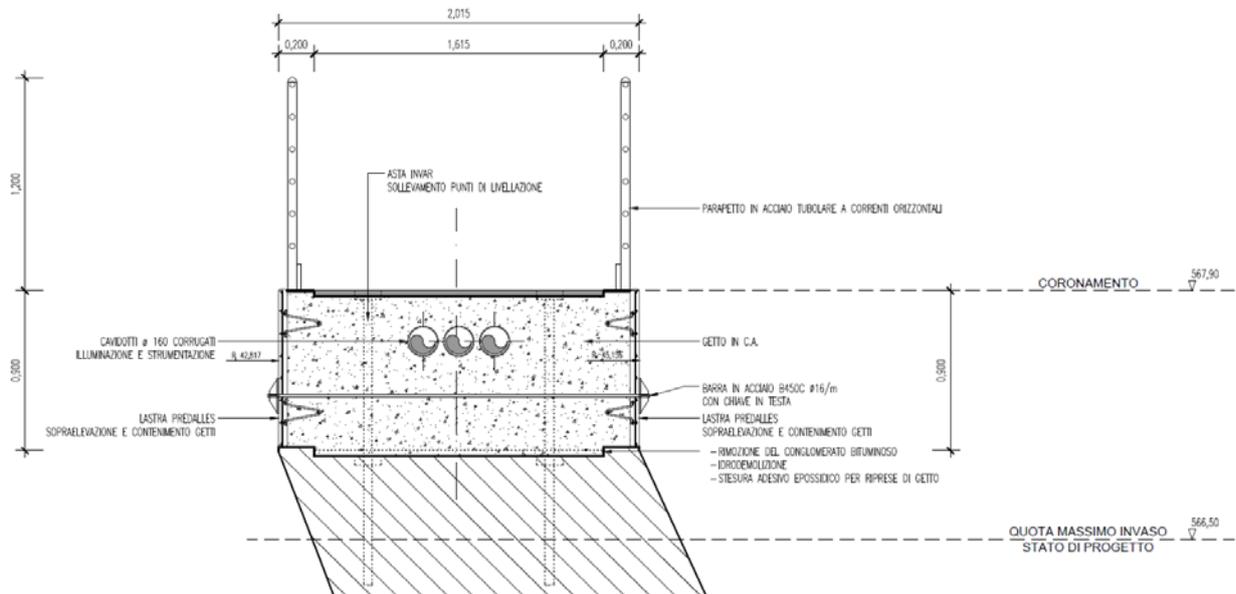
Sezione tipo del sovrizzo della diga nella sezione corrente.
